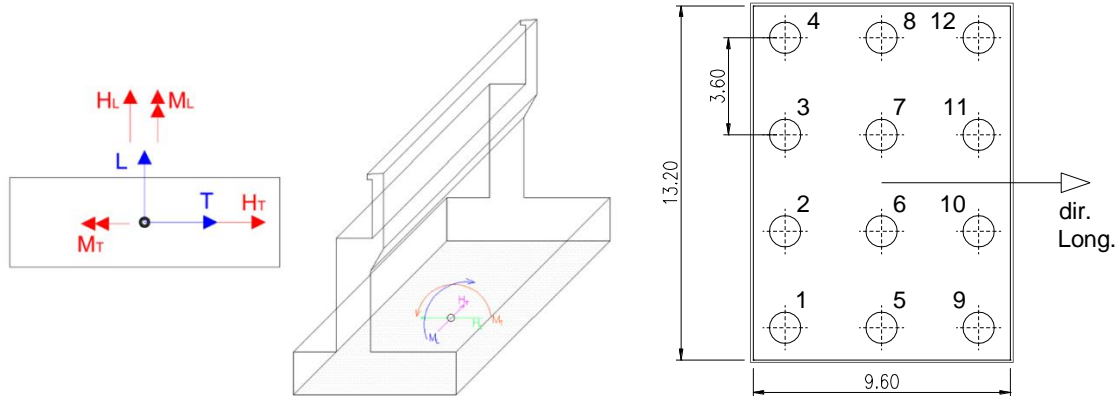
V01 – SPALLE SP2– pianta plinto e convenzione dei segni delle azioni agenti.
